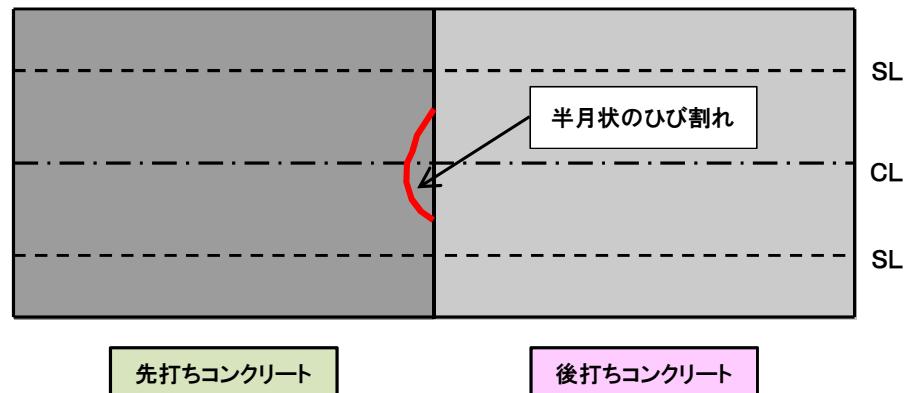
型枠押上げによる半月状のひび割れ発生のイメージ
